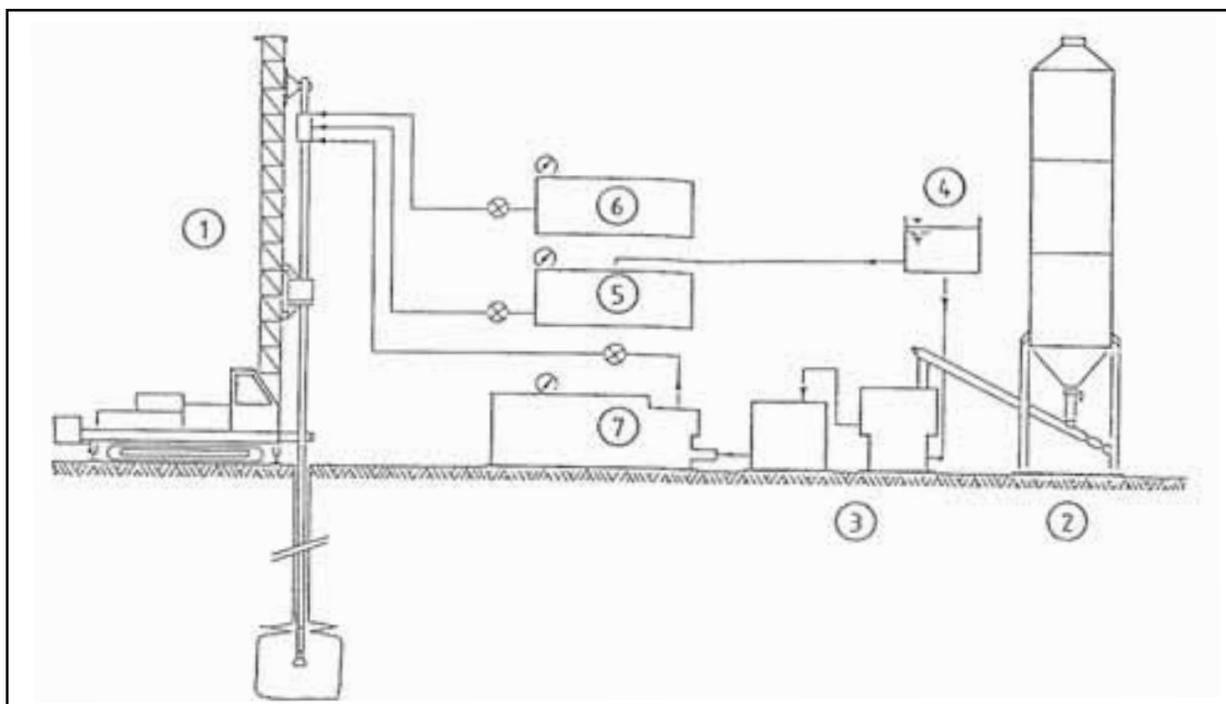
Equipamentos de campo para Jet Grouting com sistema de jato triplo.
